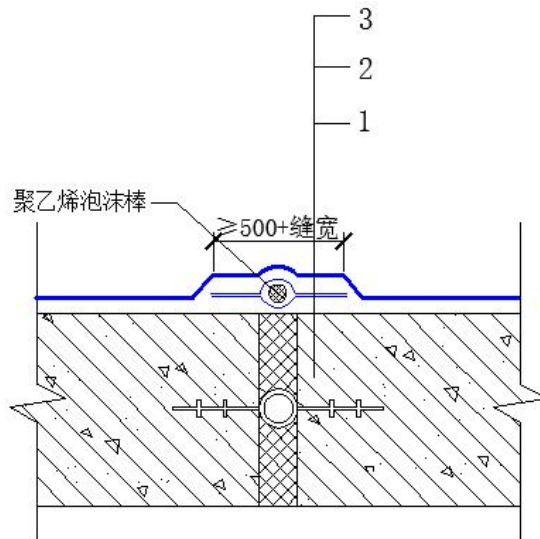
顶板及侧墙变形缝防水构造示意图
